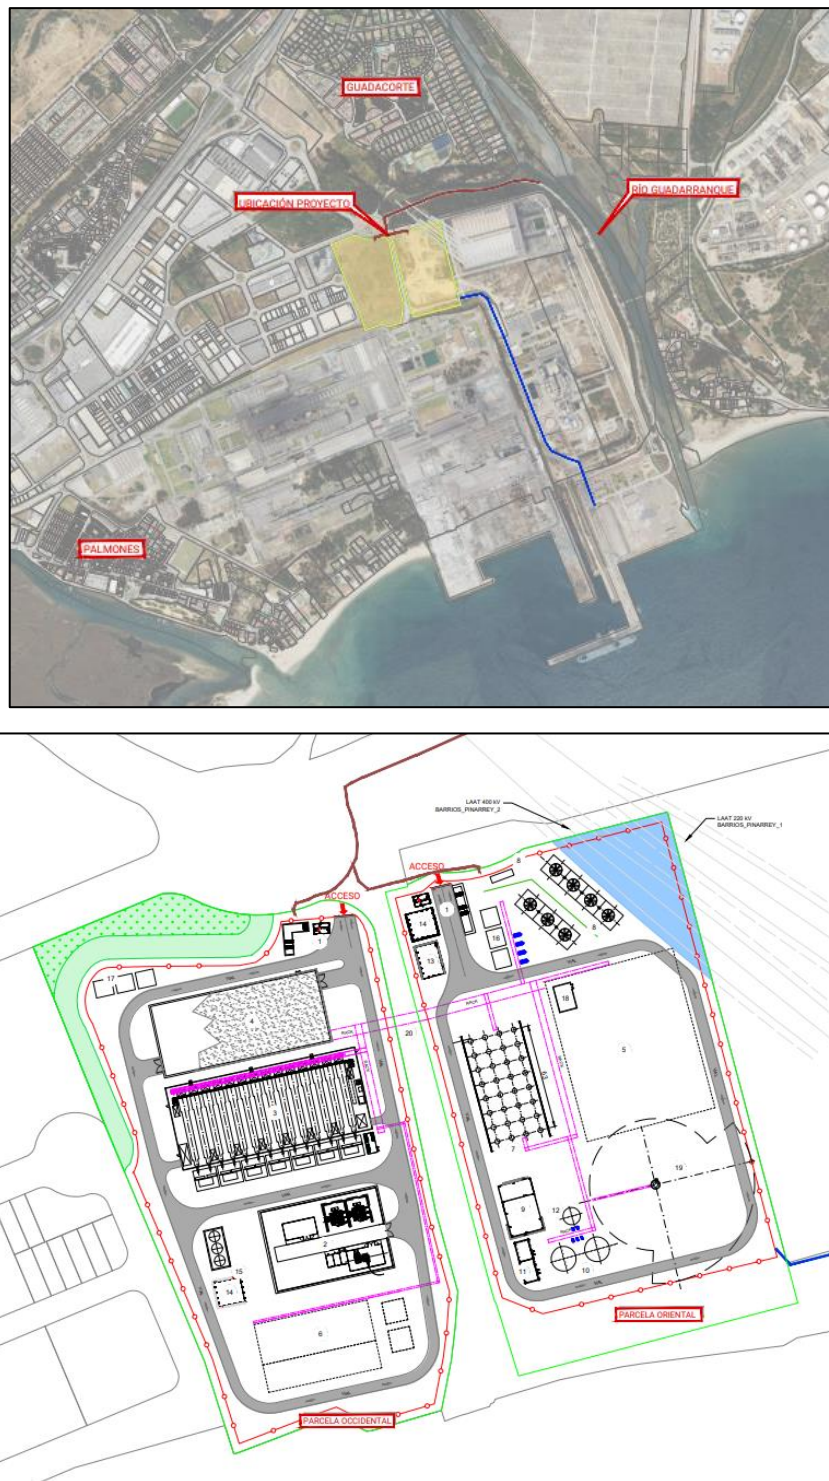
Emplazamiento y planta del Proyecto. Fuente: Proyecto Básico.
